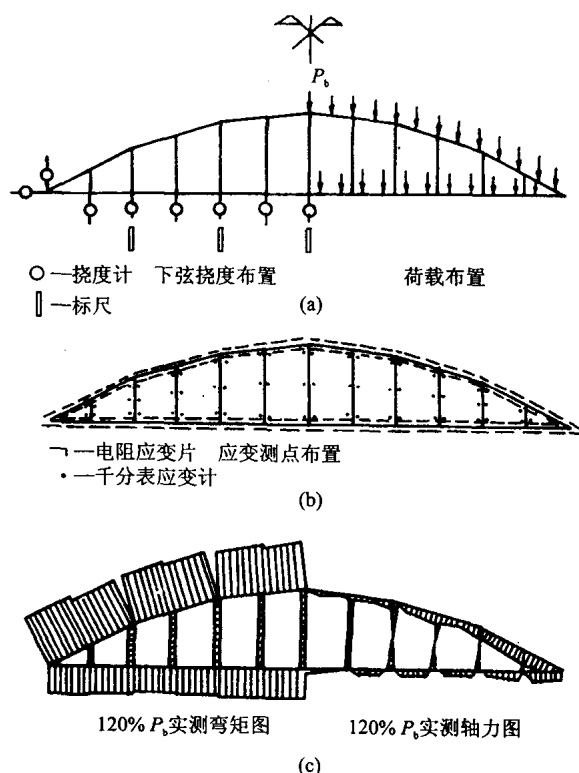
12 m 柱距 36 m 跨度预应力钢筋混凝土拱形空腹屋架的荷载布置、挠度与应变测量简图
